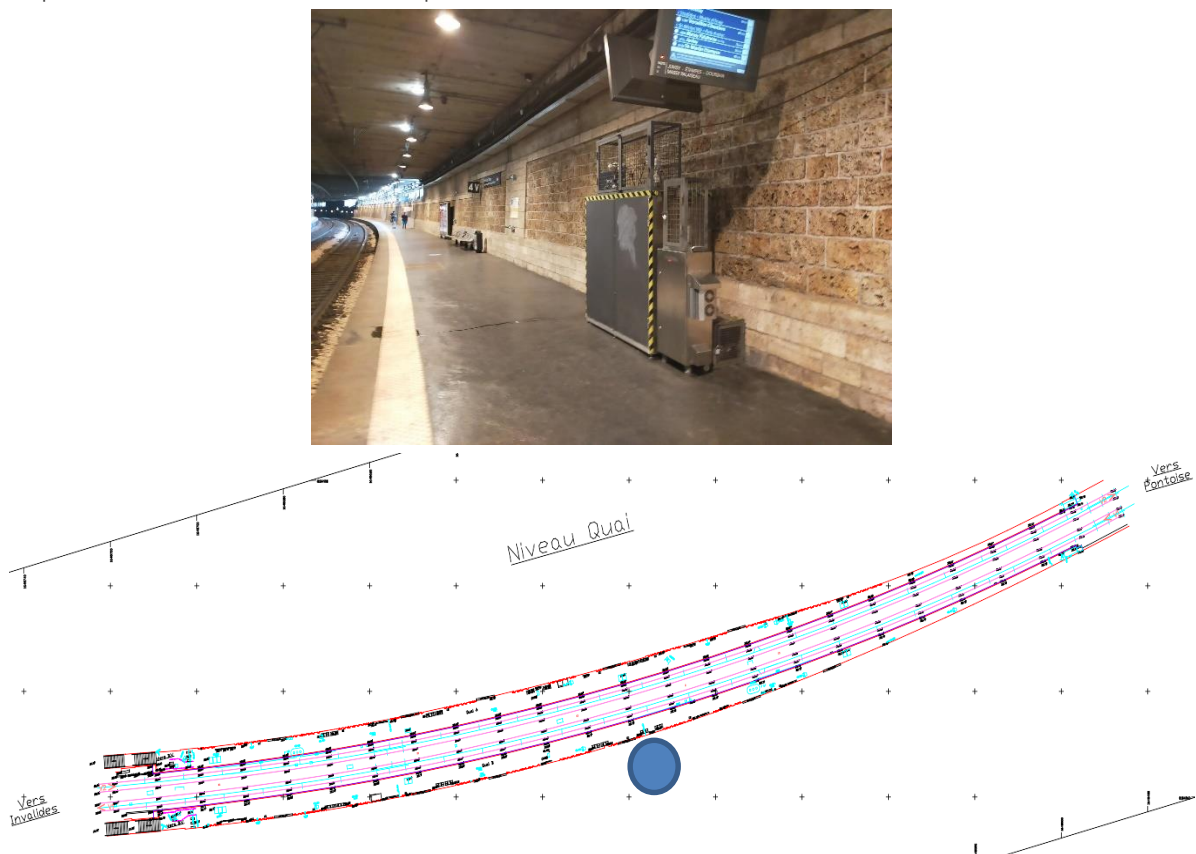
Photo de la station de mesure (quai de la gare de Pont de l'Alma, ligne RER C) et plan de la gare.
